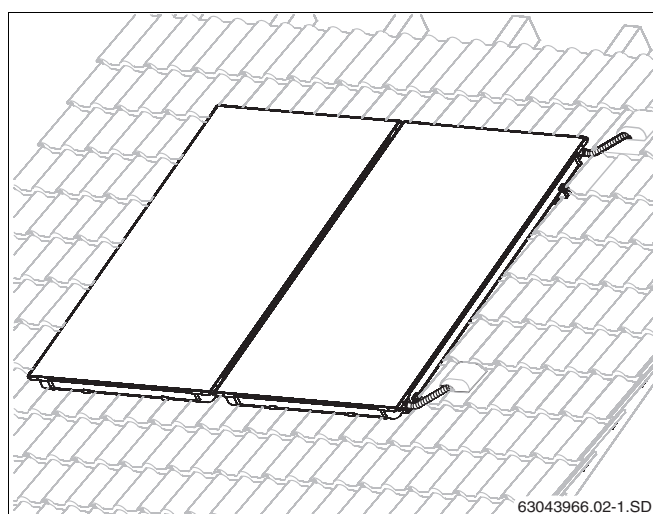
Vue d'ensemble d'une paire de capteurs, montage sur toit incliné
